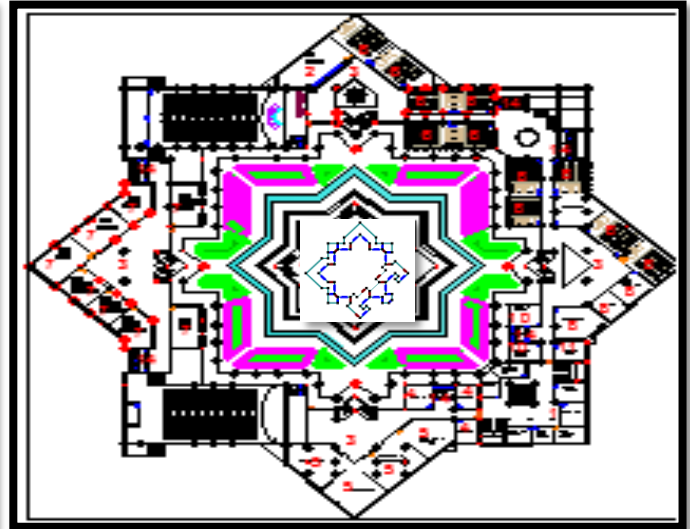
Plan de 1<sup>er</sup> étage de projet.
